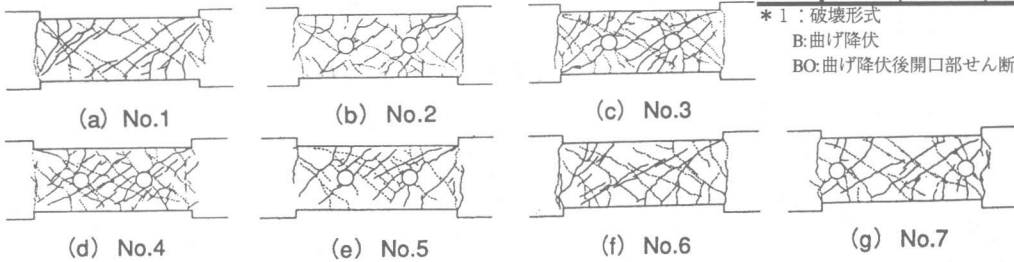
ひび割れ状況 (R=1/100rad時)
